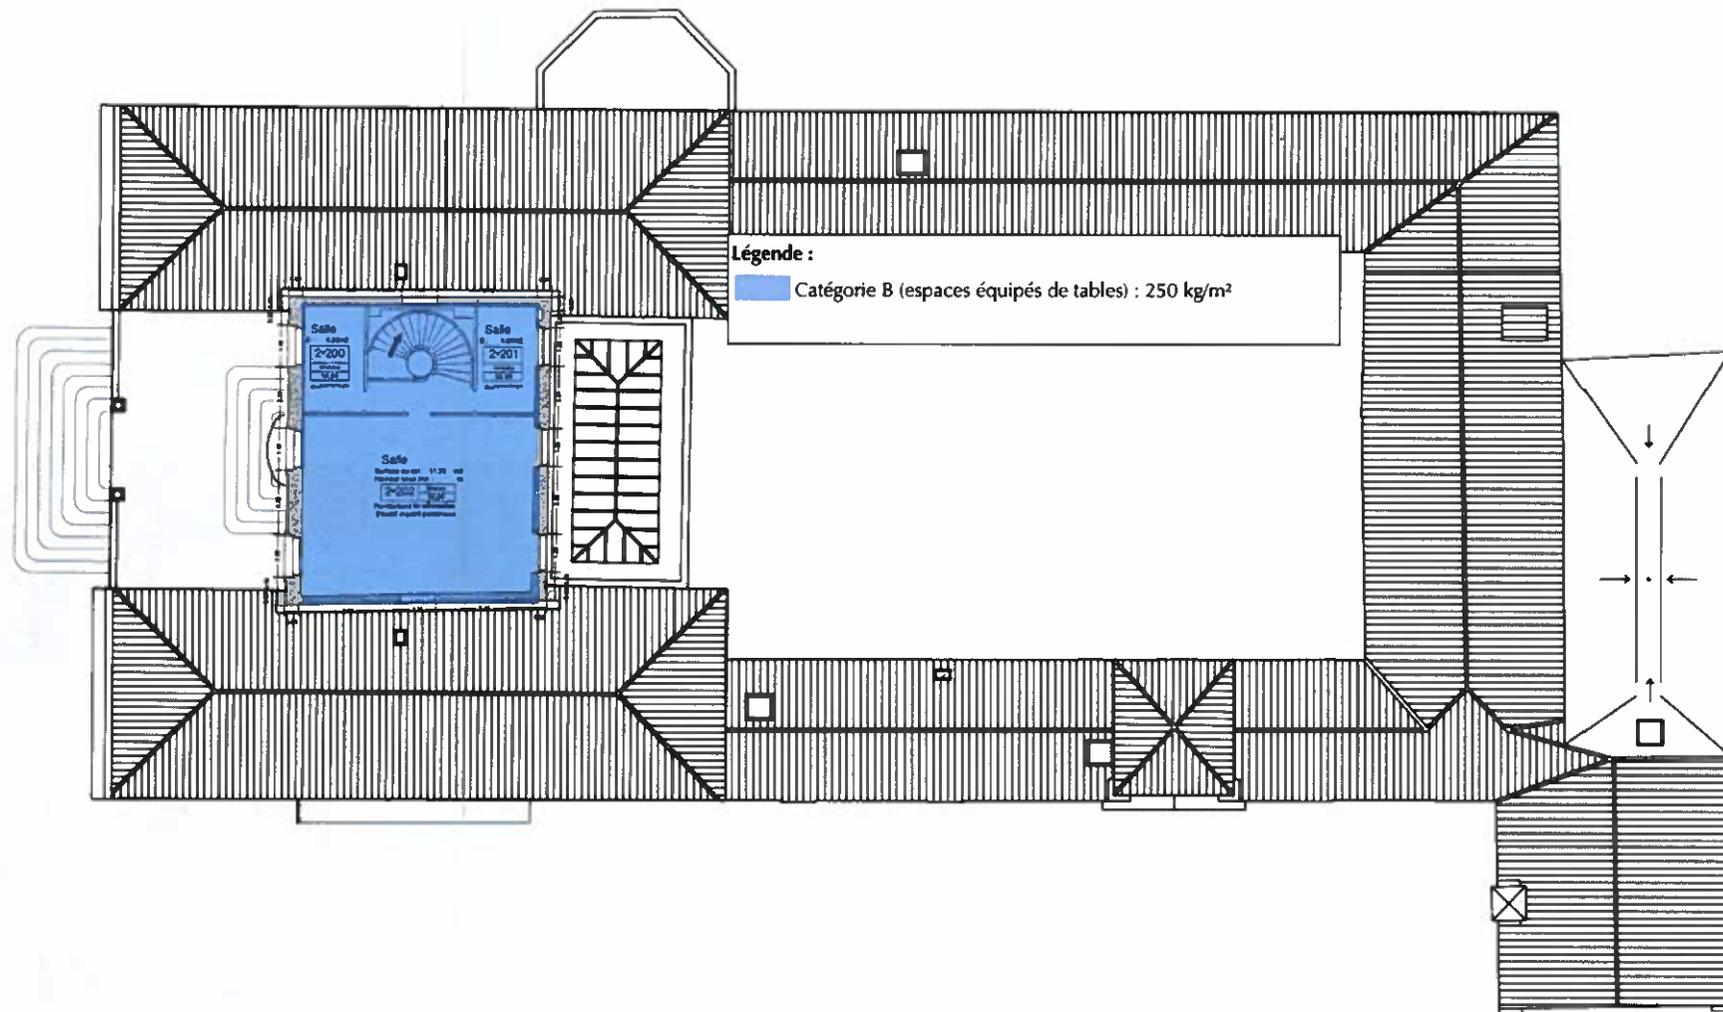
Cartographie des surcharges d'exploitation, plancher bas du deuxième étage, état existant, fond de plan transmis par l'architecte
